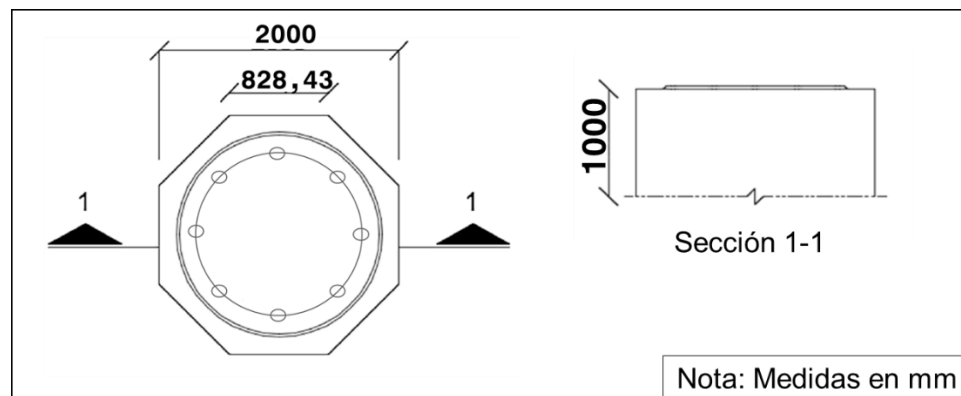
Dimensiones del pedestal. Fuente: Autor.
